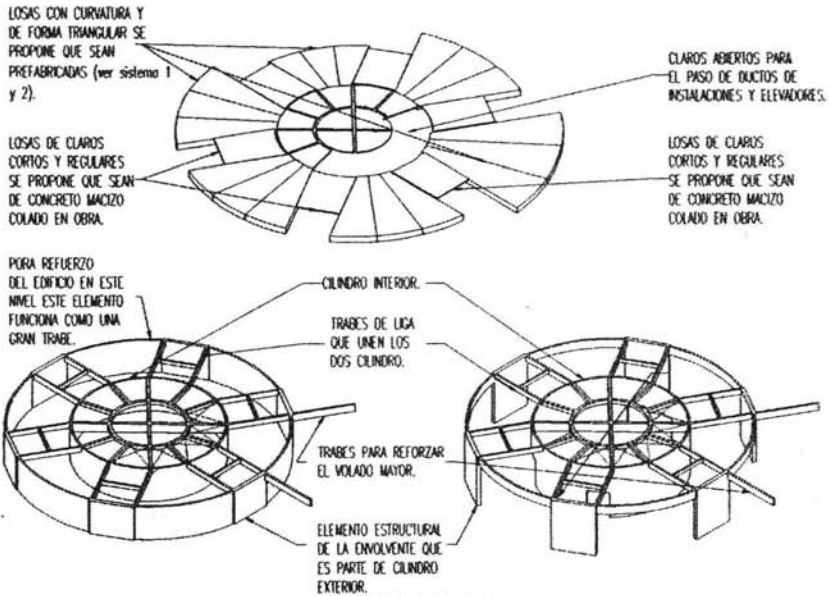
Disposición de los elementos estructurales por piso en la torre PISO 4 y 5 al 13.
